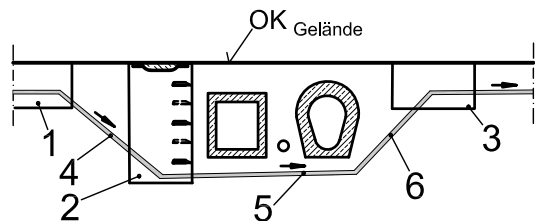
Schräge Dükeräste (Prinzipskizze)
